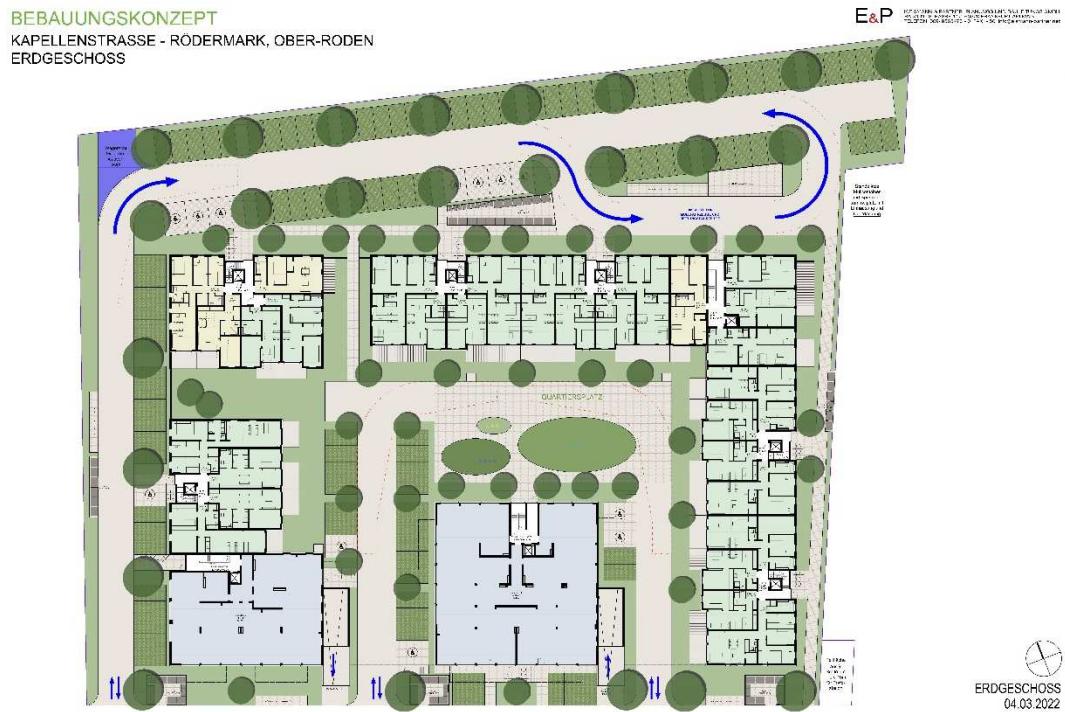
Bebauungskonzept Erdgeschoss vom 04.03.2022, Klaus Eismann & Partner Planungs- und Bauleitungs GmbH, Frankfurt (blau: Gewerbe, grün/gelb: Wohnen)
